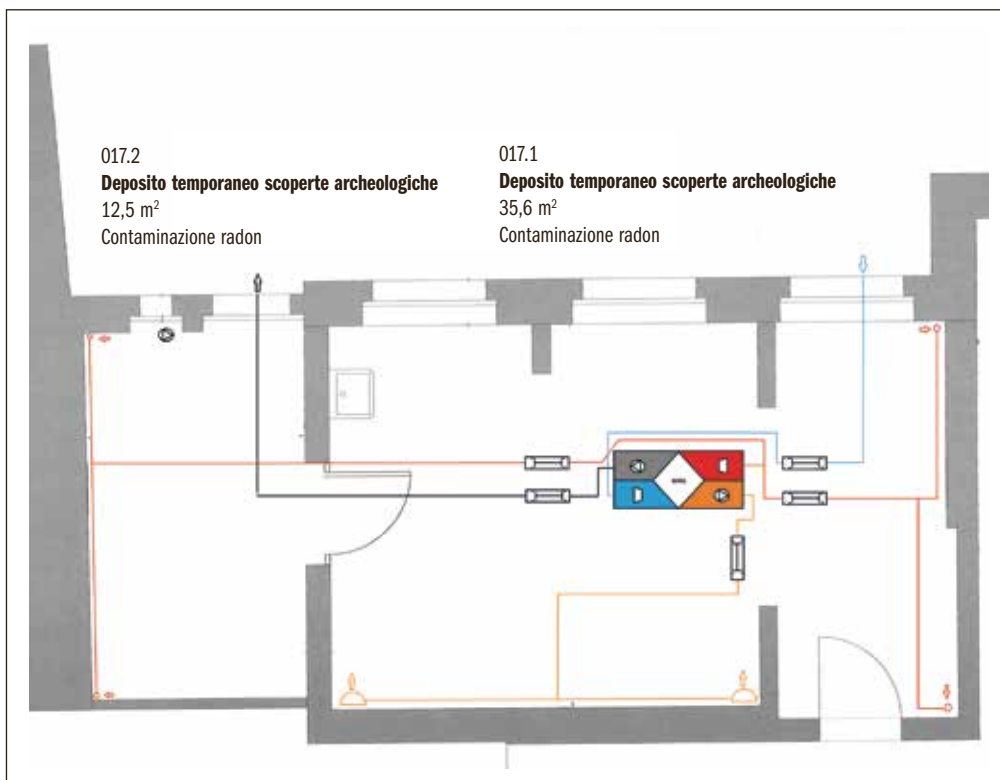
Schema di ventilazione dell'area di lavoro.
